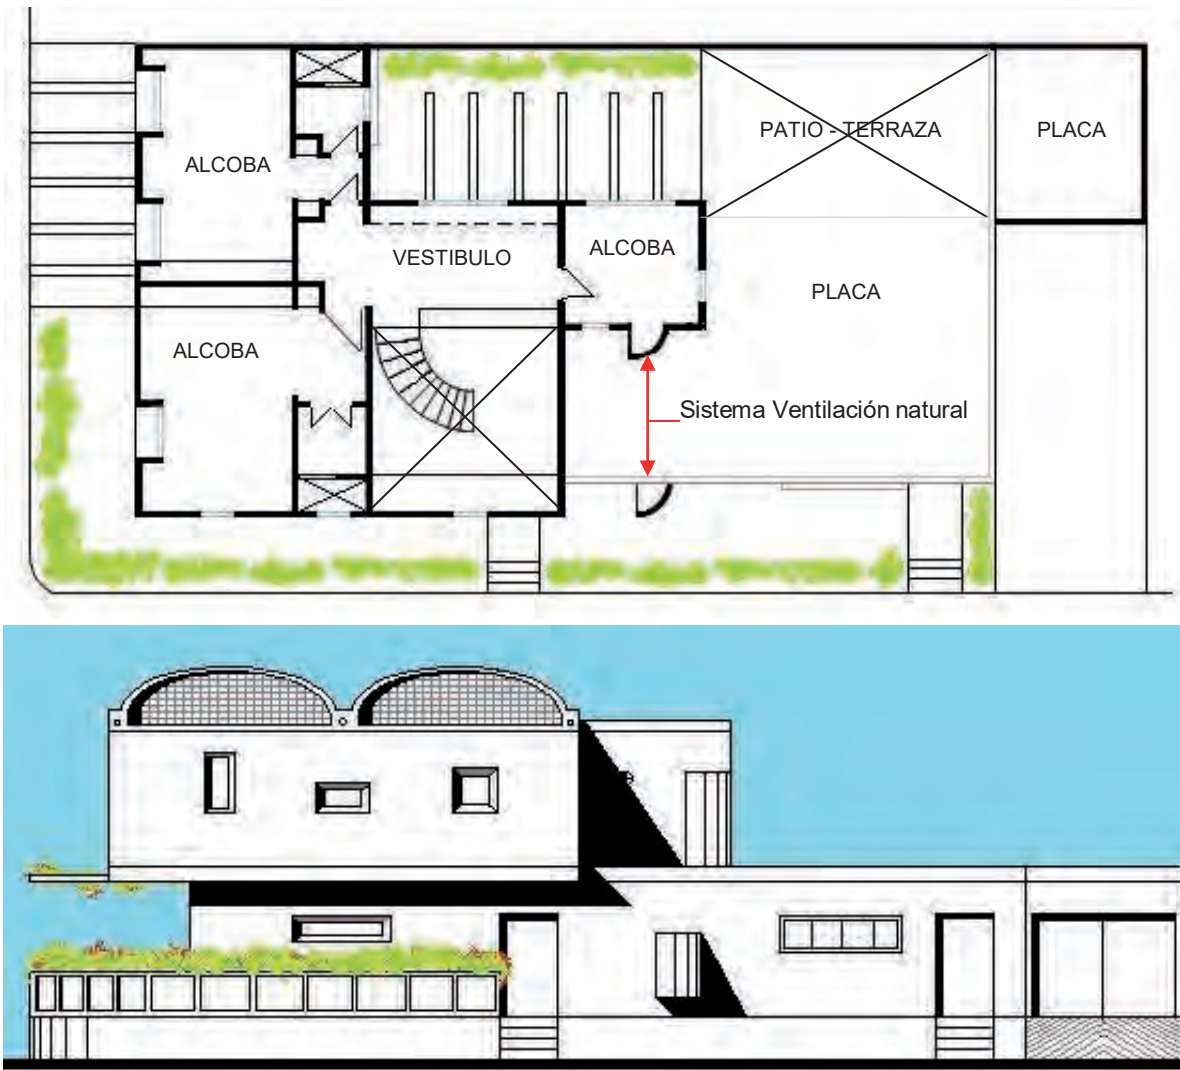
Planos casa Lemaitre: Segundo piso y Fachada principal. Se observa el sistema de cubierta abovedado con calados para ventilación superior y los vanos para captación de luz solar y ventilación natural.
